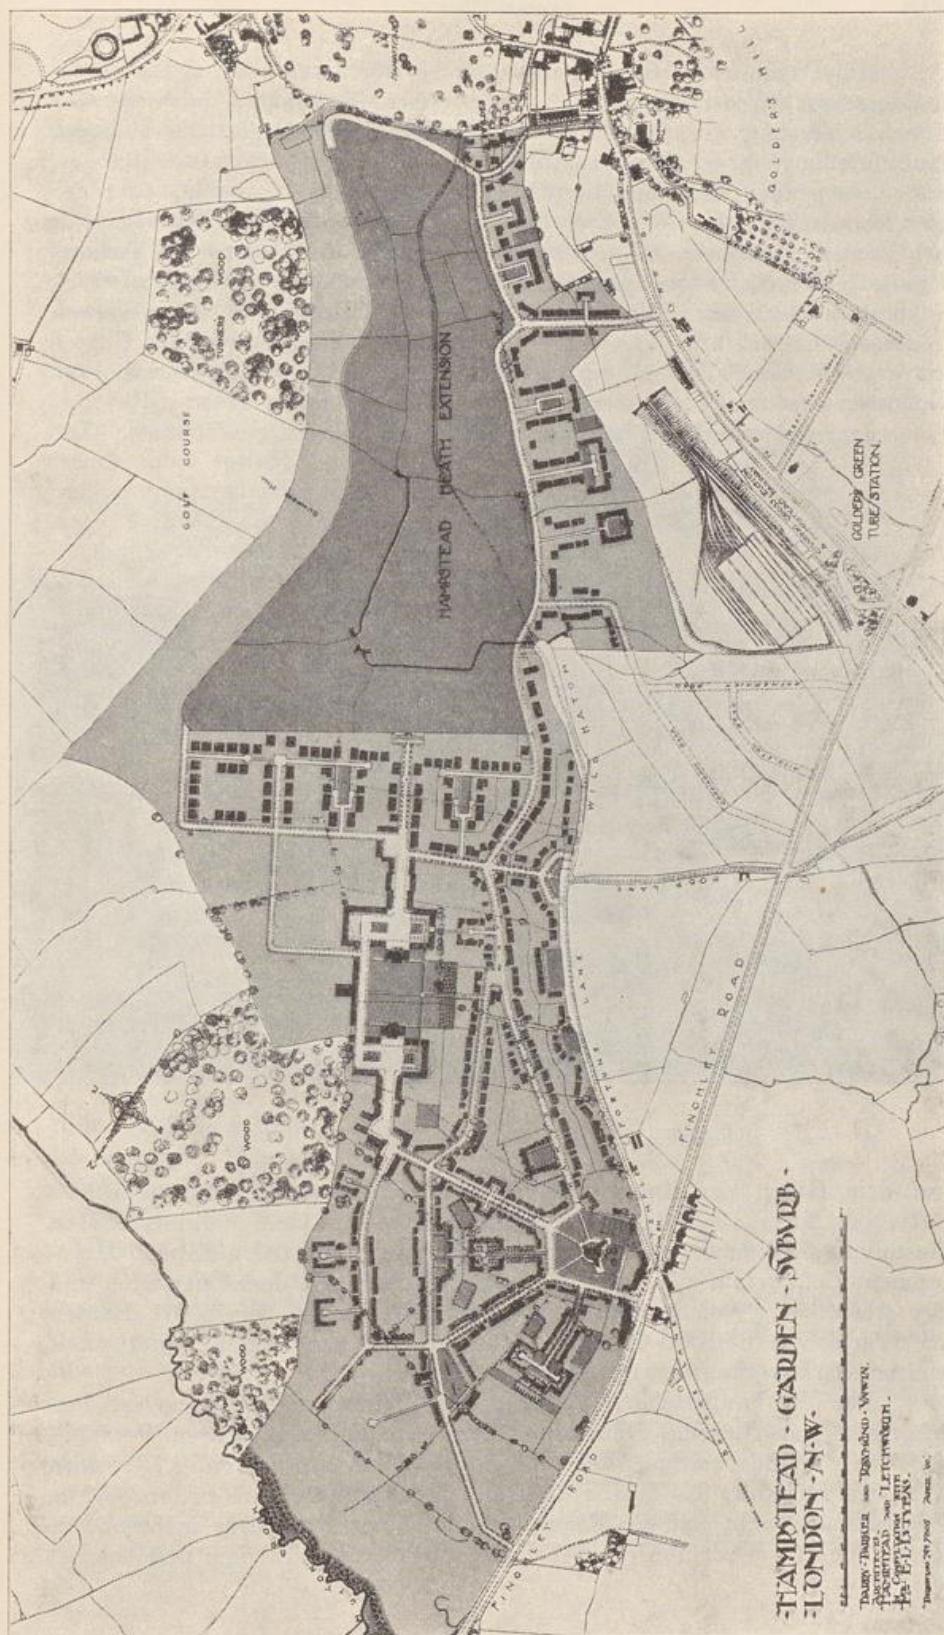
Bebauungsplan der Gartenstadt Hampstead-London.
